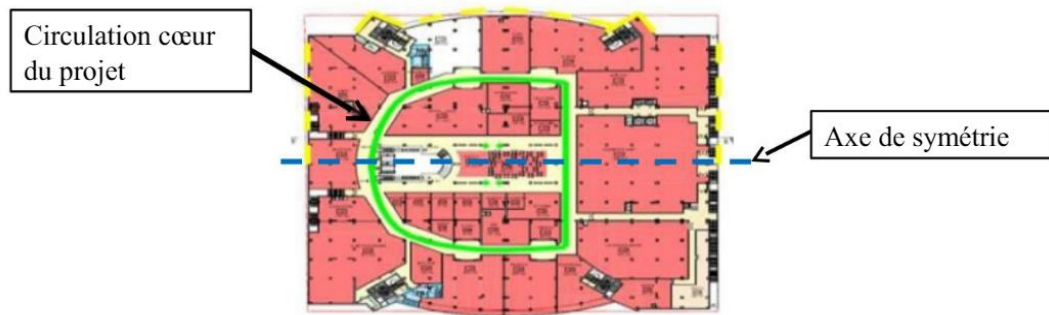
Plan de sous sol de centre commercial Bab Ezzouar
